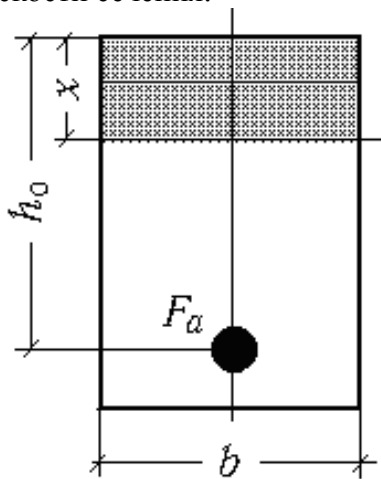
Нормальное сечение изгибаемой железобетонной балки с трещиной при однослойном армировании
